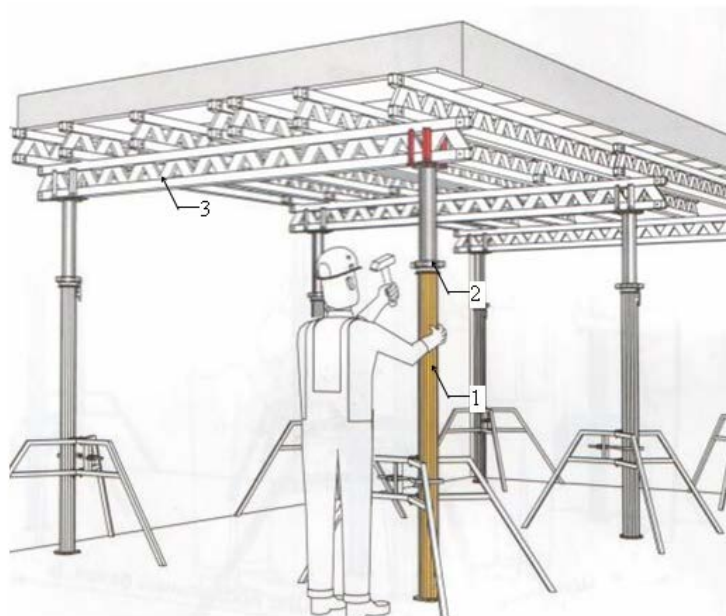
Опускание настила опалубки: 1 – основная стойка; 2 – регулировочная гайка; 3 – продольная балка
